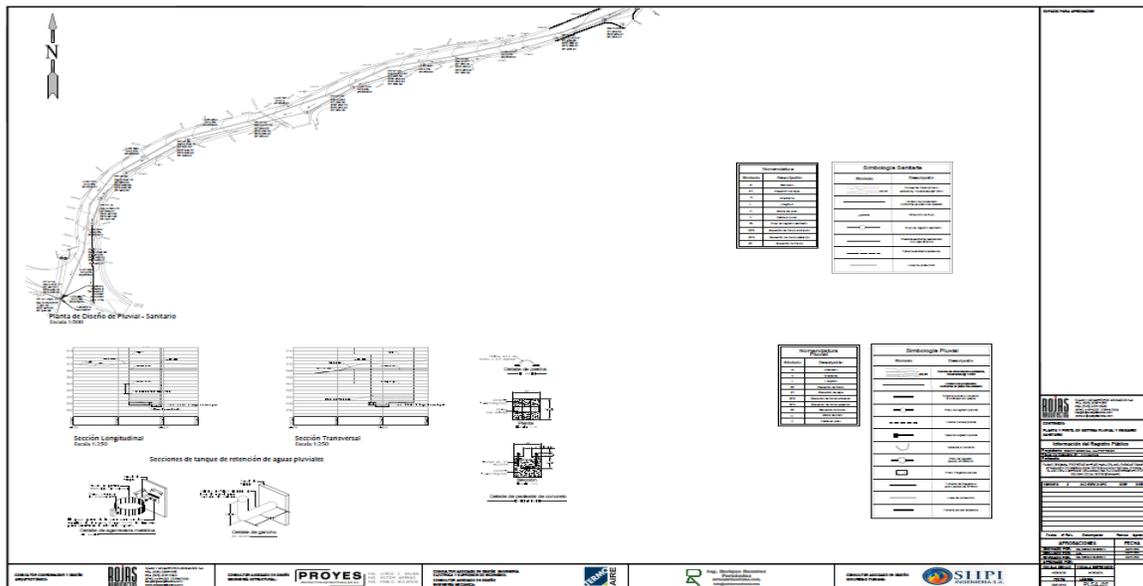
Planta de Conjunto. Sección # 2, trayecto de tubería pluvial y sanitaria sobre sobre calle cantonal hasta descarga en Río Bermúdez, lámina # PLSA-02 de los planos presentados.
